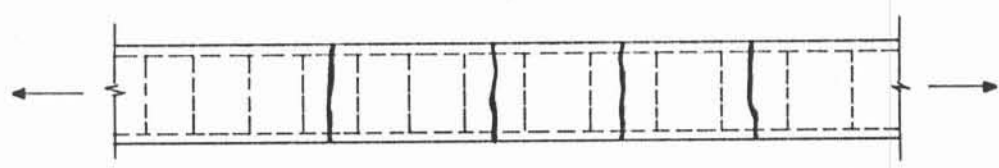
Fissuras provocadas por esforços de tração em tirantes.
